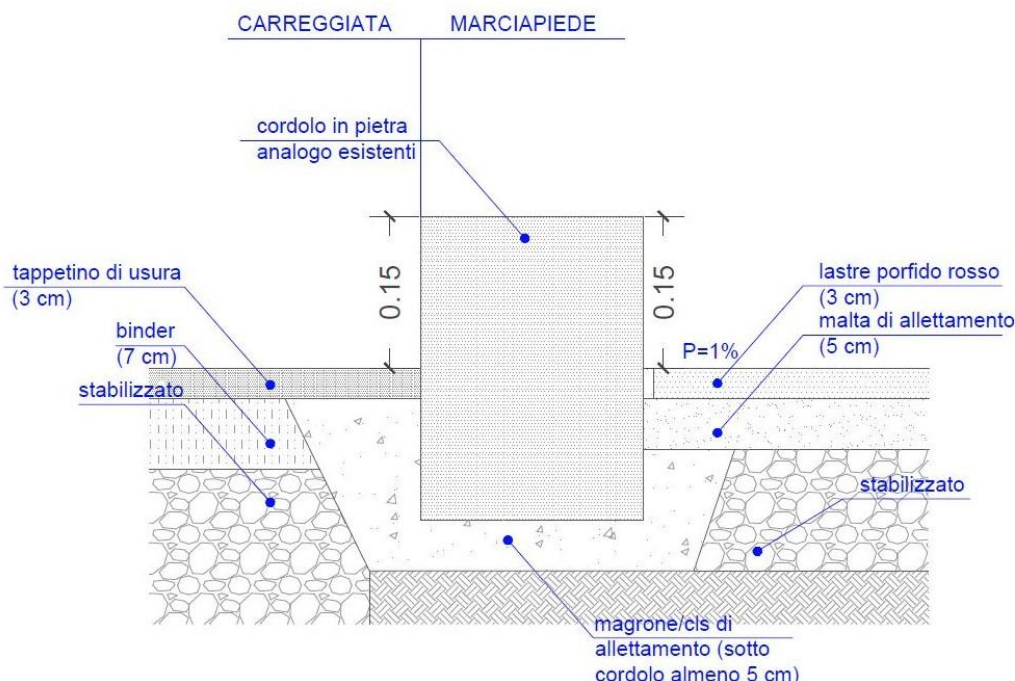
sezione tipo marciapiede con cordolo estradossato
